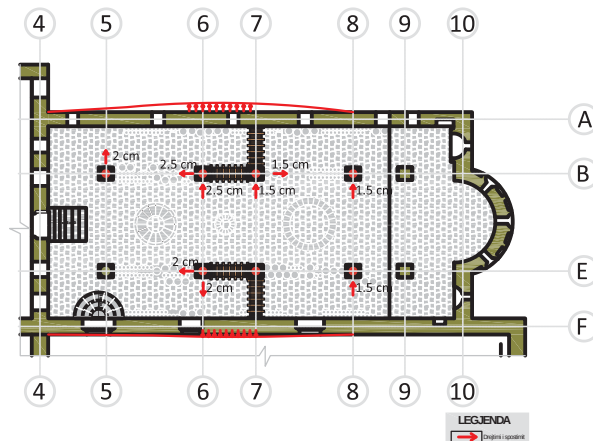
Plani i spostimit të kolonave dhe muraturës (prezantimi i Grupit 3)
